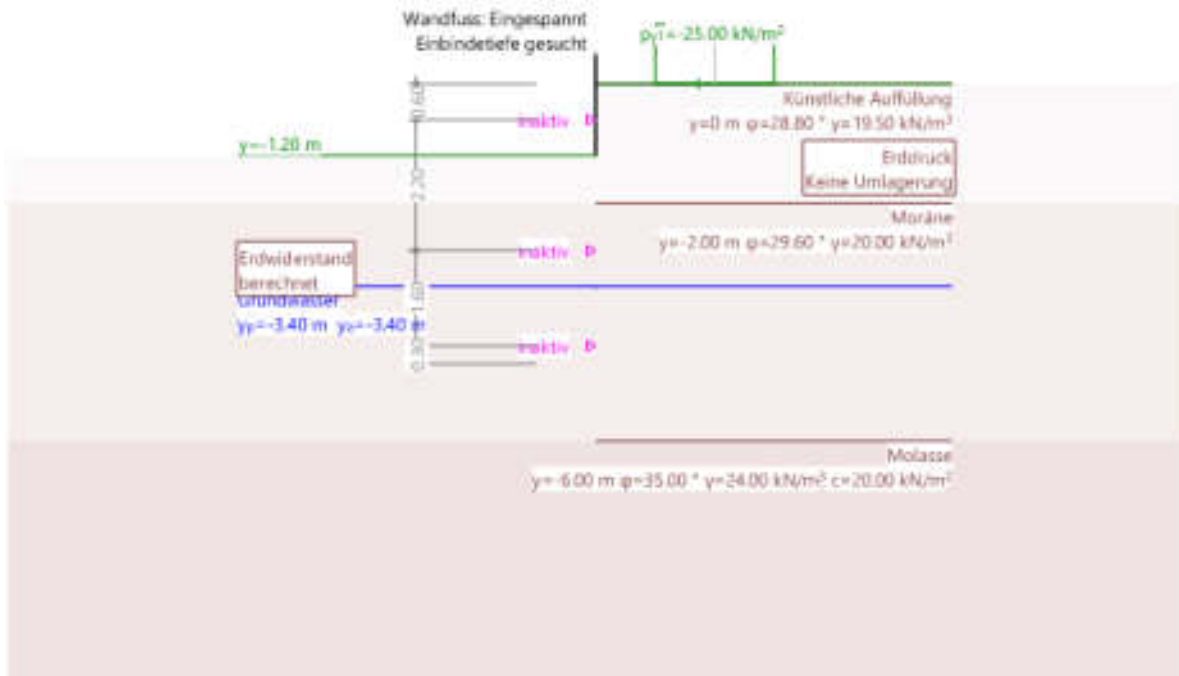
Baugrube vor Einbau 1. Spriesslage
